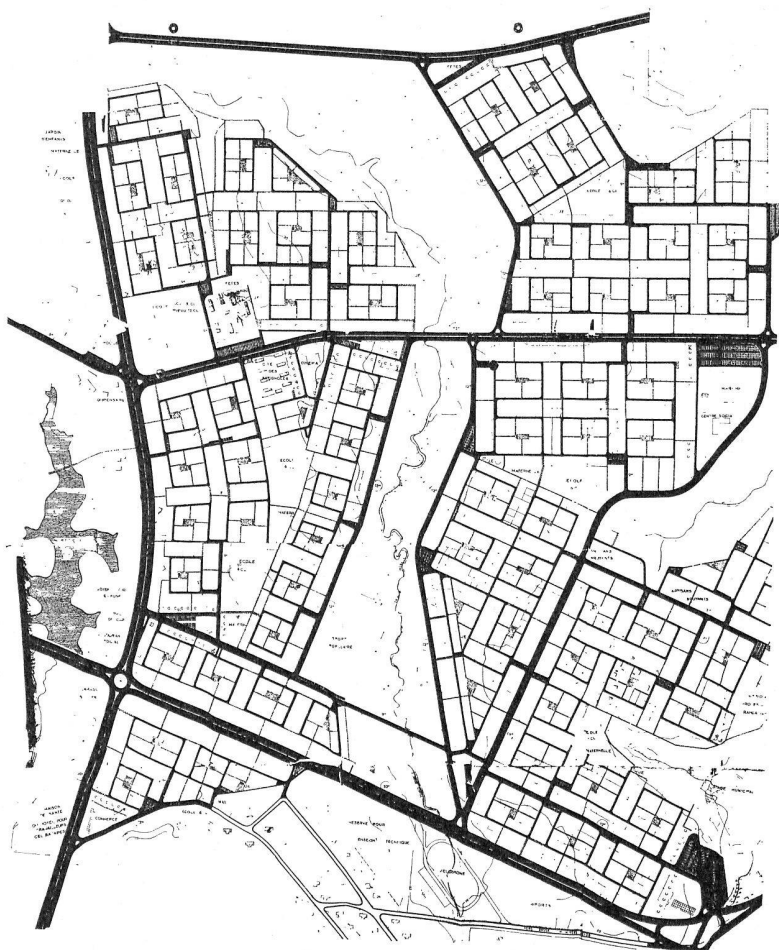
Cameroun. Deido (Douala). Exemple d'application des trames d'accueil à un plan d'ensemble. (Voir nos photos.) (Service de l'habitat du Cameroun.)
